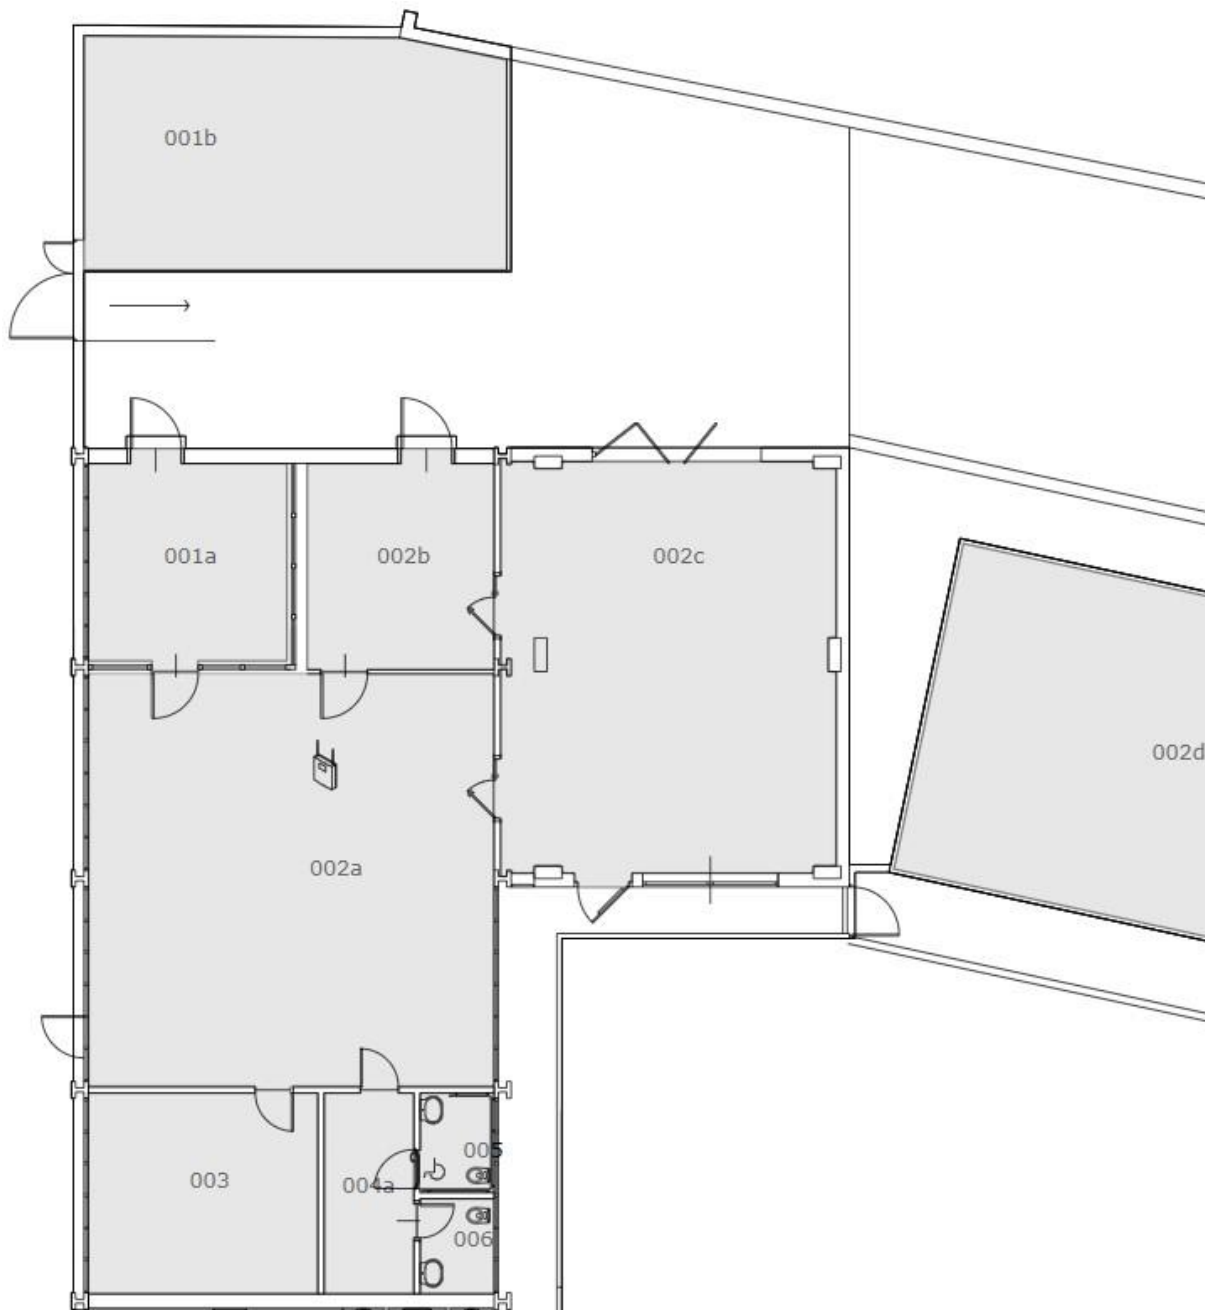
planimetria di emergenza dell'edificio B16A, lato SPLab.
